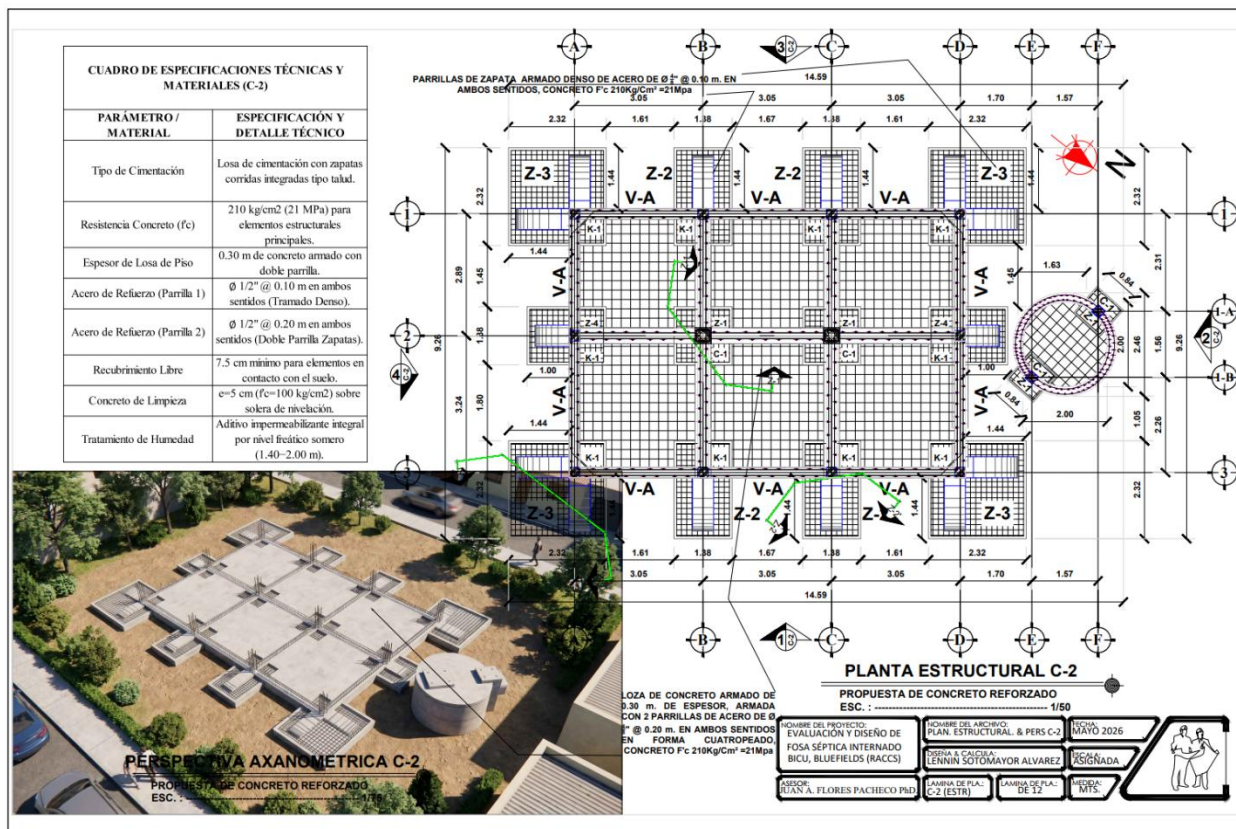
Planta estructural y perspectiva axonométrica de la alternativa de fosa séptica en concreto reforzado para el internado de BICU.
